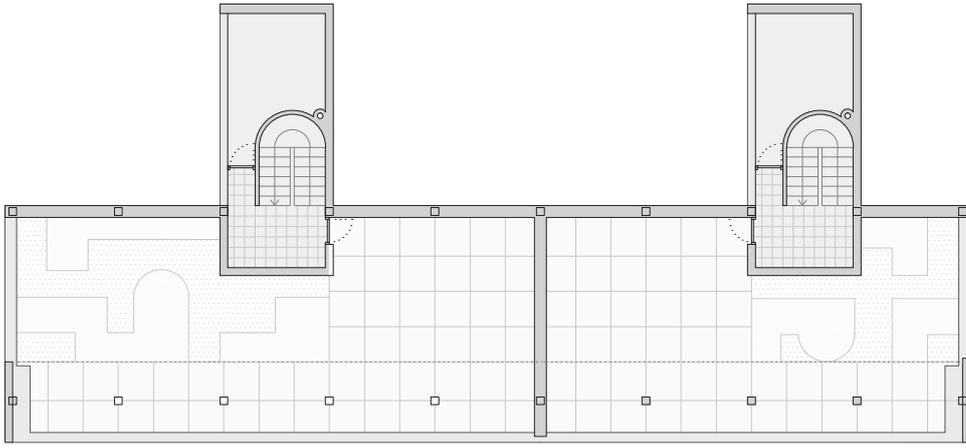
Planta baja del bloque C2 de la Weissenhofsiedlung.
